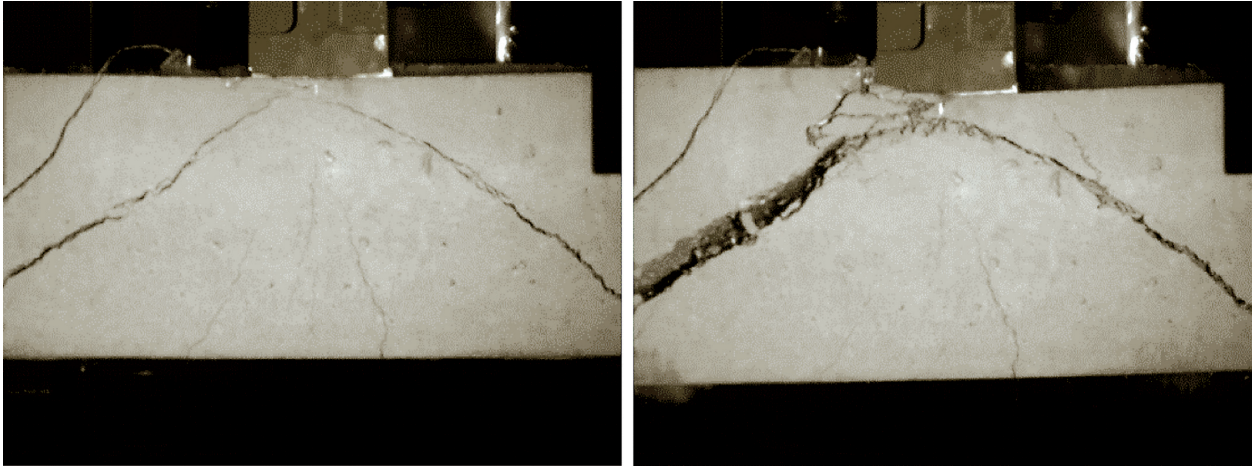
Exemple de fissuration d'une poutre en béton armé sans renfort transversal sous l'effet de la chute d'un projectile.
